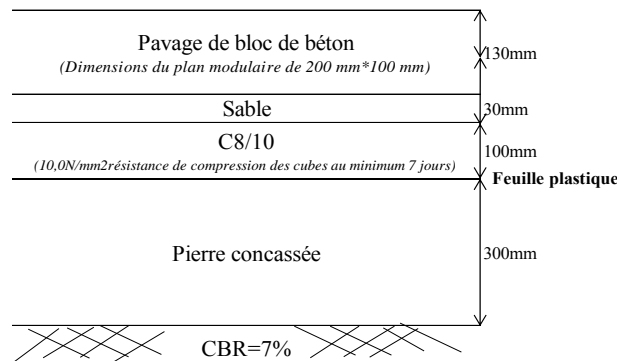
Structure de chaussée pour le tablier du terminal et la route
